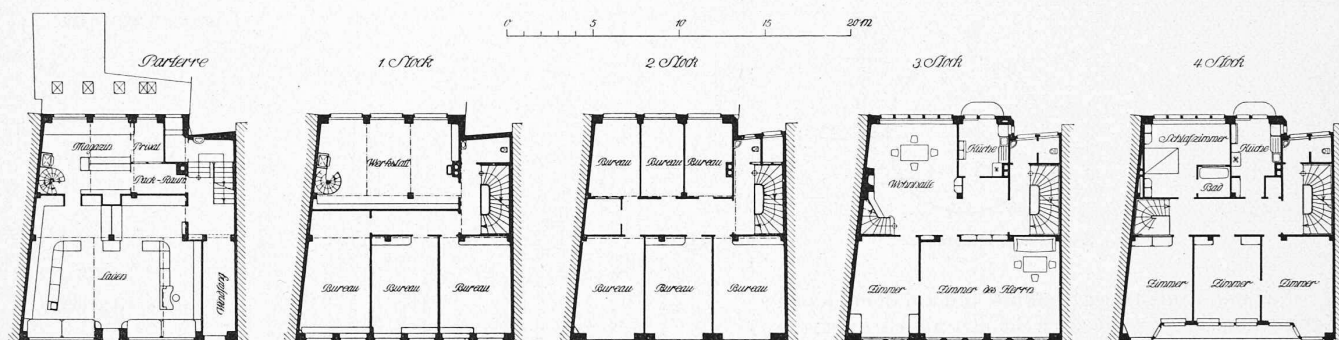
bis 5. Haus Walz in St. Gallen. — Grundrisse 1:400.
